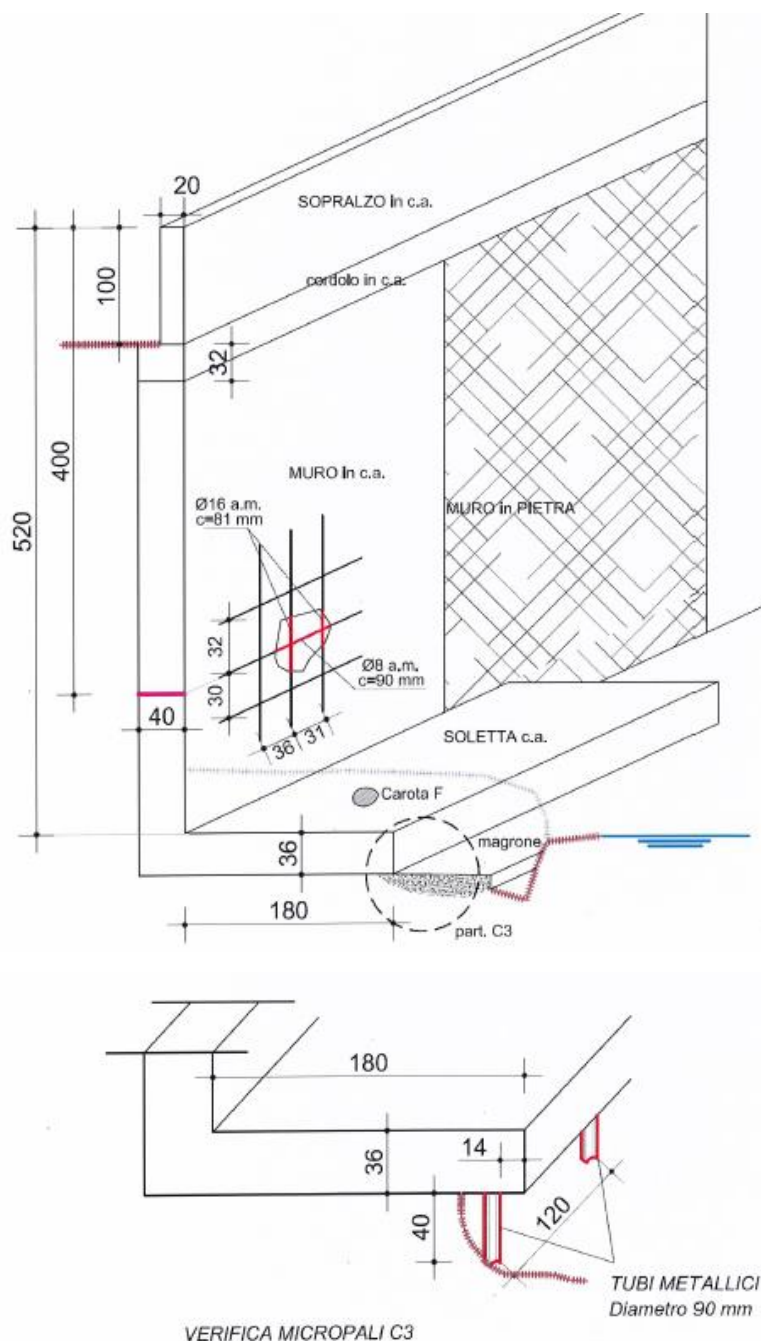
Sezione tipologica strutturale rilevata in sito
